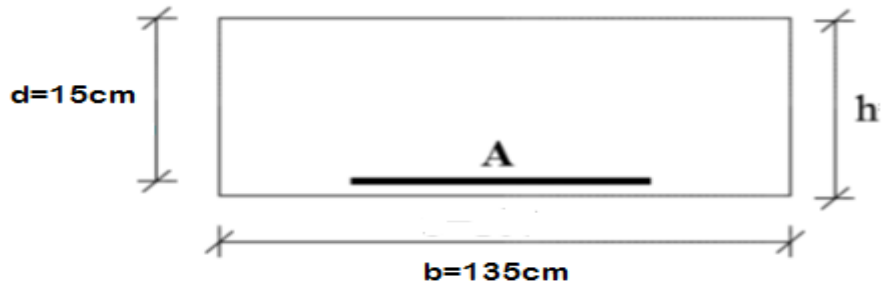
schéma de la section d'escalier à ferrailer.
